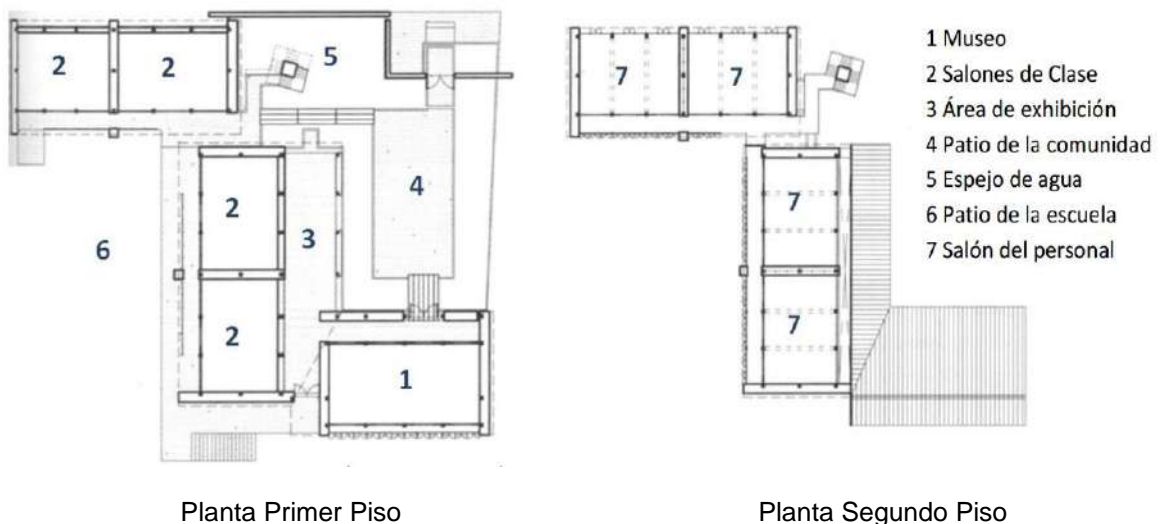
Plantas Arquitectónicas del Proyecto. <sup>112</sup>
